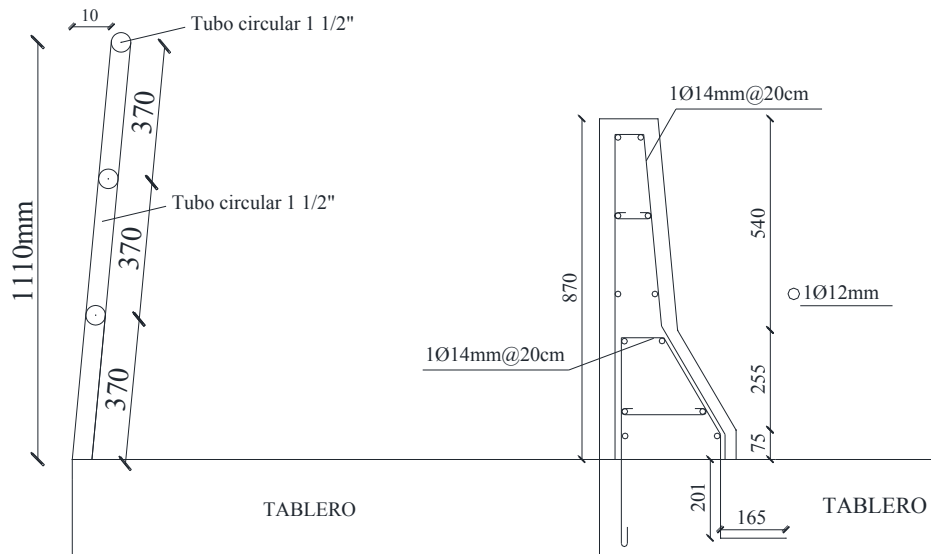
Protección lateral combinada: Protección peatonal metálica y protección vehicular con postes de hormigón y vallas vehiculares de acero
